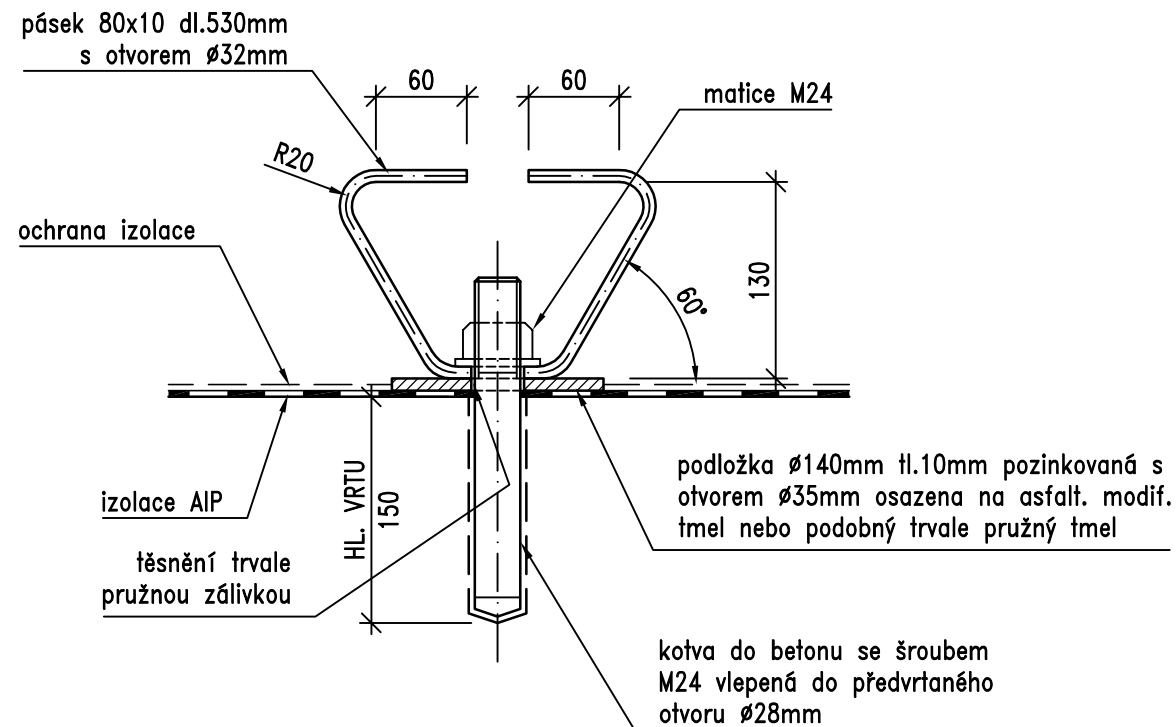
HLAVA ZÁVARNÉ ZDI
